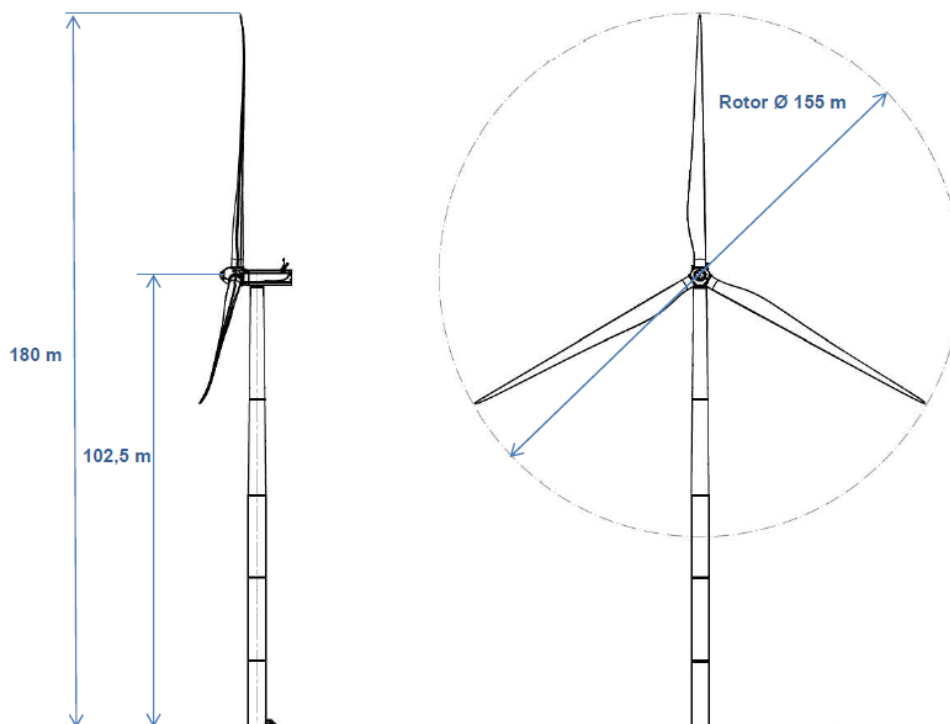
Vista prospettica e laterale dell'aerogeneratore SIEMENS GAMESA SG 6.0 - 155 da 6,0 MW.
